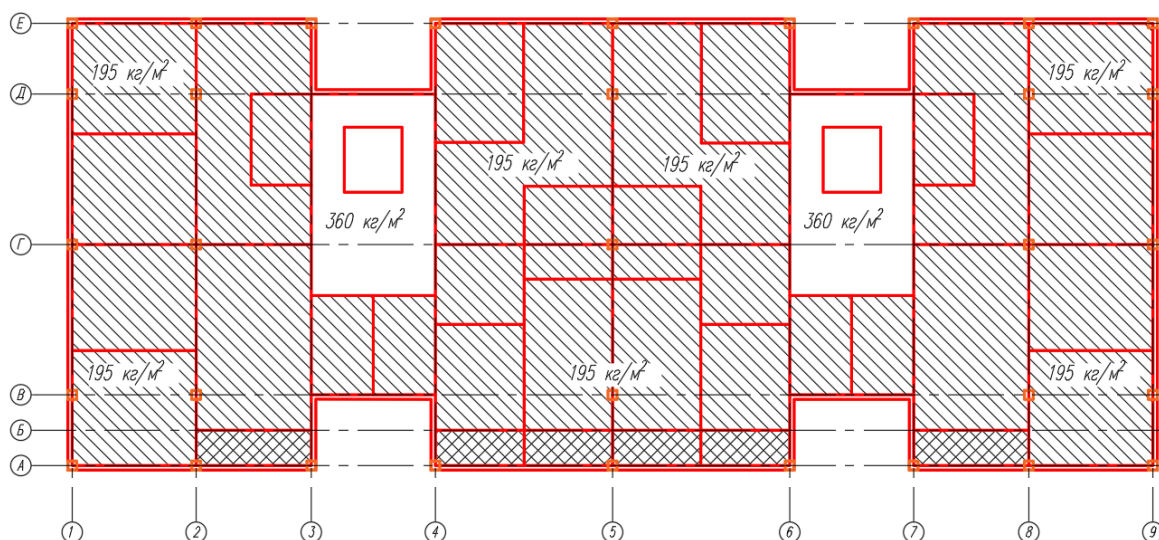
Схема приложения полезных нагрузок на перекрытие (2-5 эт), кг/м²
